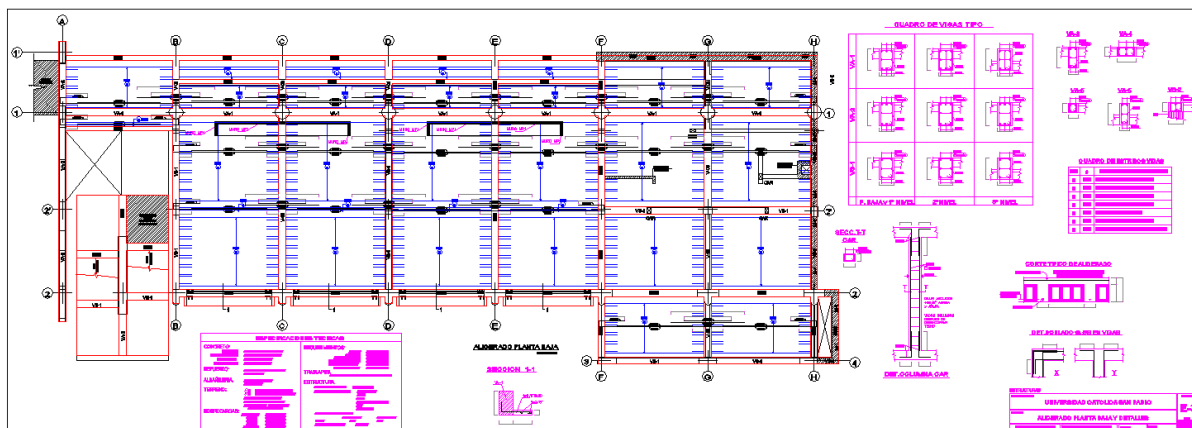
Plano estructural y detalles de la planta baja del pabellón María Nieves Bustamante de la Universidad Católica San Pablo.
